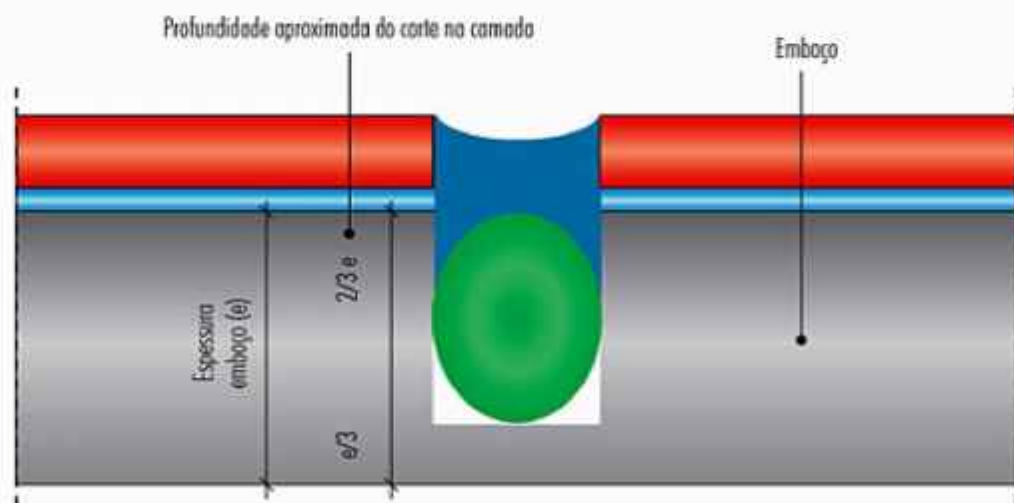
Perfil da junta de movimentação com corte parcial no emboço para controle de fissuração.
